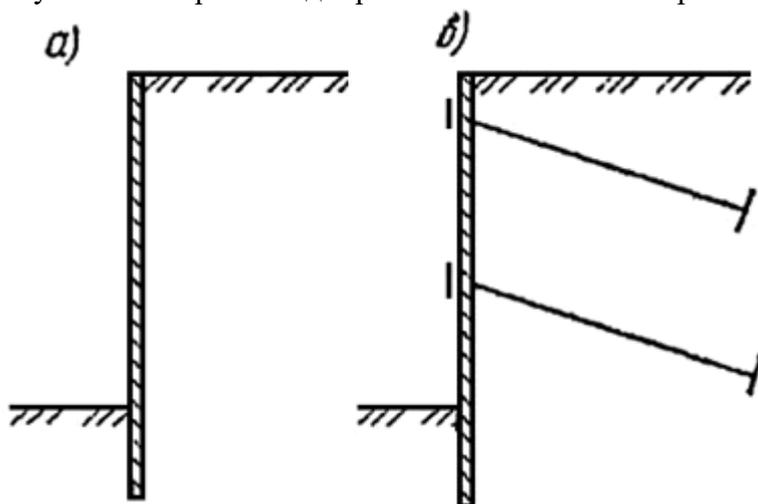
Схемы гибких подпорных стен: а — консольная; б — с анкерами
